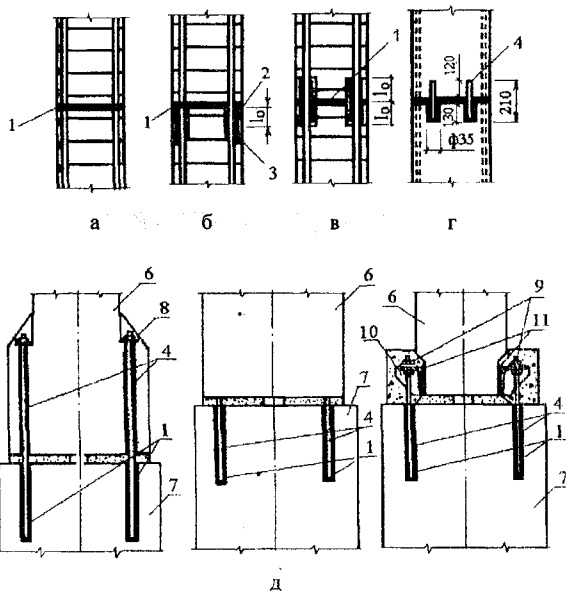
Клеевые стыки сборных железобетонных колонн (а, б, в), свай (г) и сборных железобетонных колонн с бесстаканными фундаментами (д): 1 – клеевой шов; 2 – муфта; 3 – сварной шов; 4 – выпуски арматуры; 5 – анкерное отверстие; 6 – колонна; 7 – фундамент; 8 – инвентарная гайка; 9 – крепежная гайка; 10 – деталь для выверки и крепления колонны; 11 – закладная деталь
